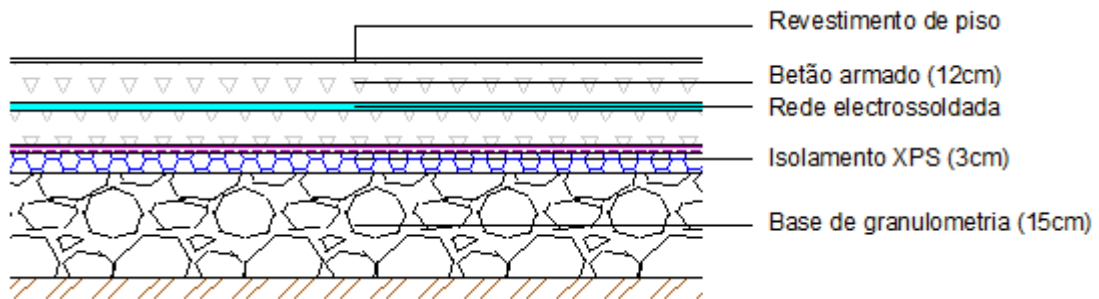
Pormenor construtivo de pavimentos enterrados e pavimentos térreos
